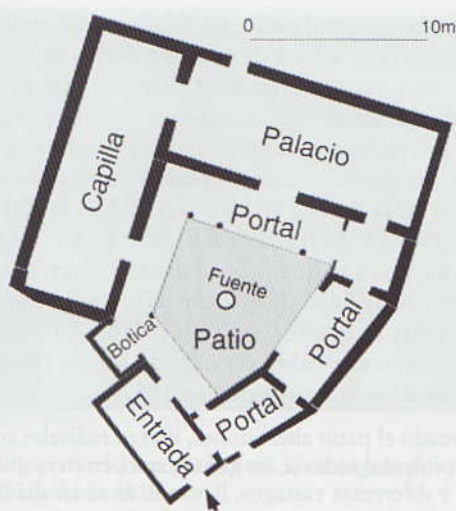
Casa llamada del Temple. Plano hipotético de planta baja, según J. Passini.
